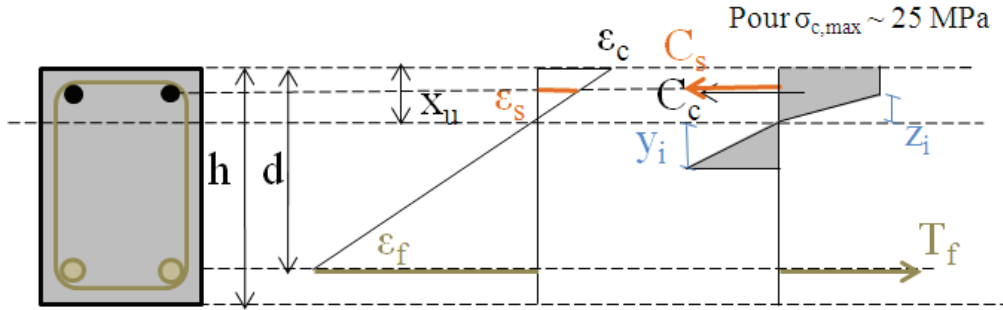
Forces s'exerçant sur la section centrale d'une poutre en phase 3
